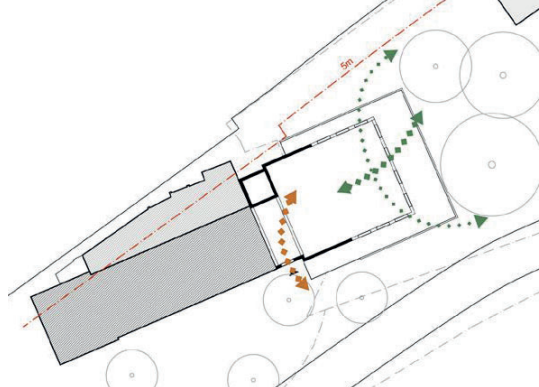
Schematischer Grundriss Erweiterung Hotel
